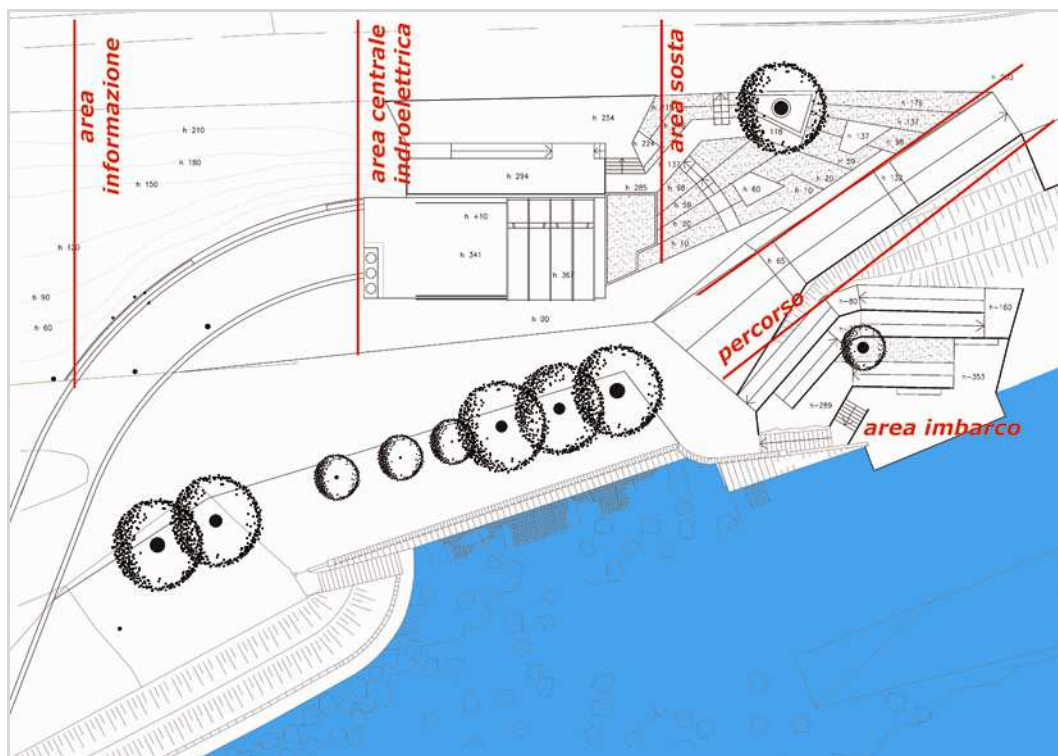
Suddivisione delle aree di progetto: pianta delle coperture
